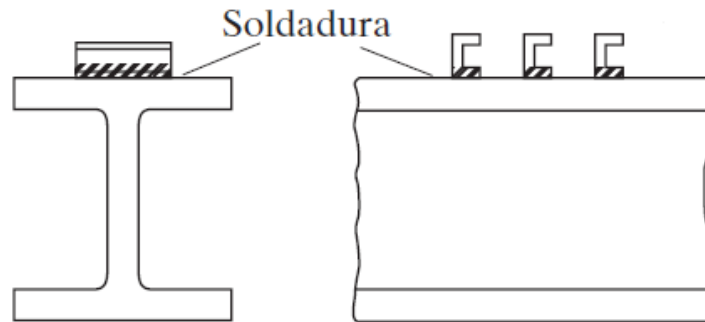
Conectores tipo canal en el ala superior de la viga (Fuente: Jack C. McCormac 5ª Edición)
